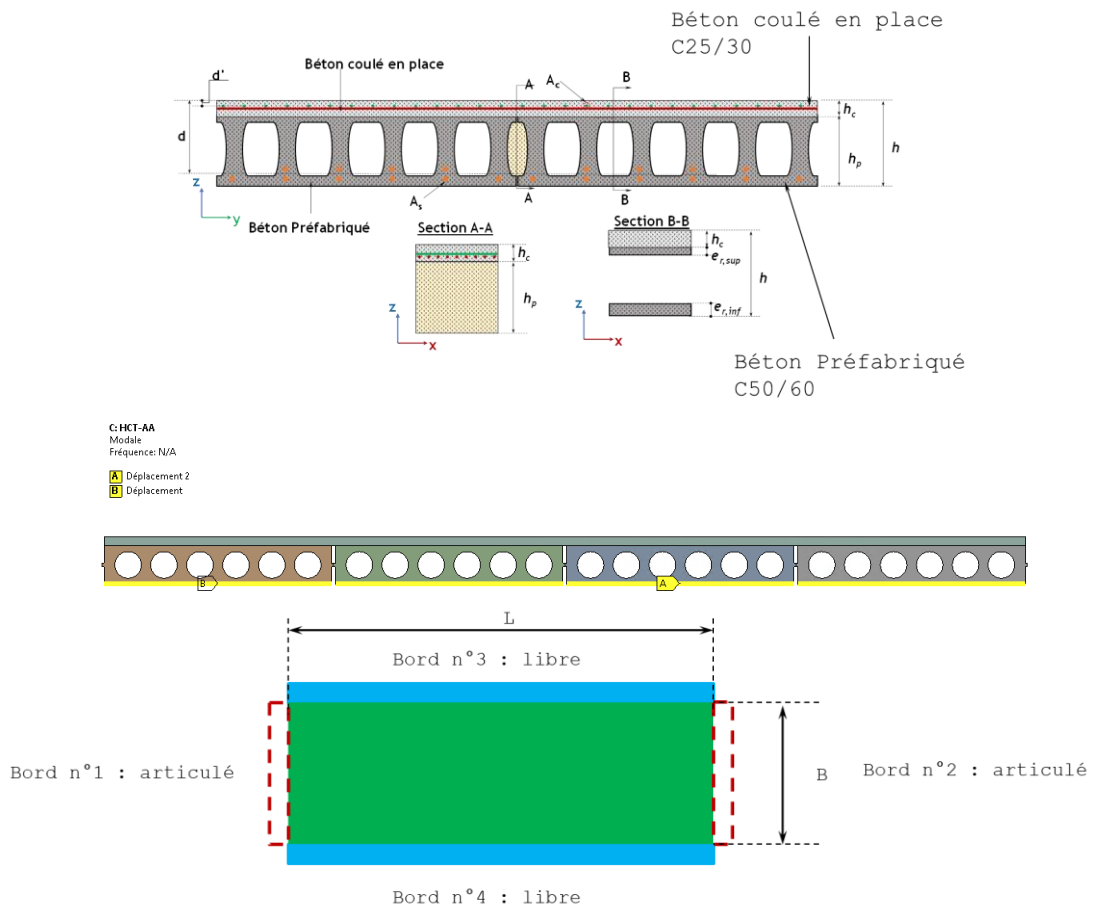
Modèle de calcul, géométrie du plancher à dalles alvéolées avec une dalle collaborante de 5 cm, avec deux bords opposés articulés et deux autres bords libres
